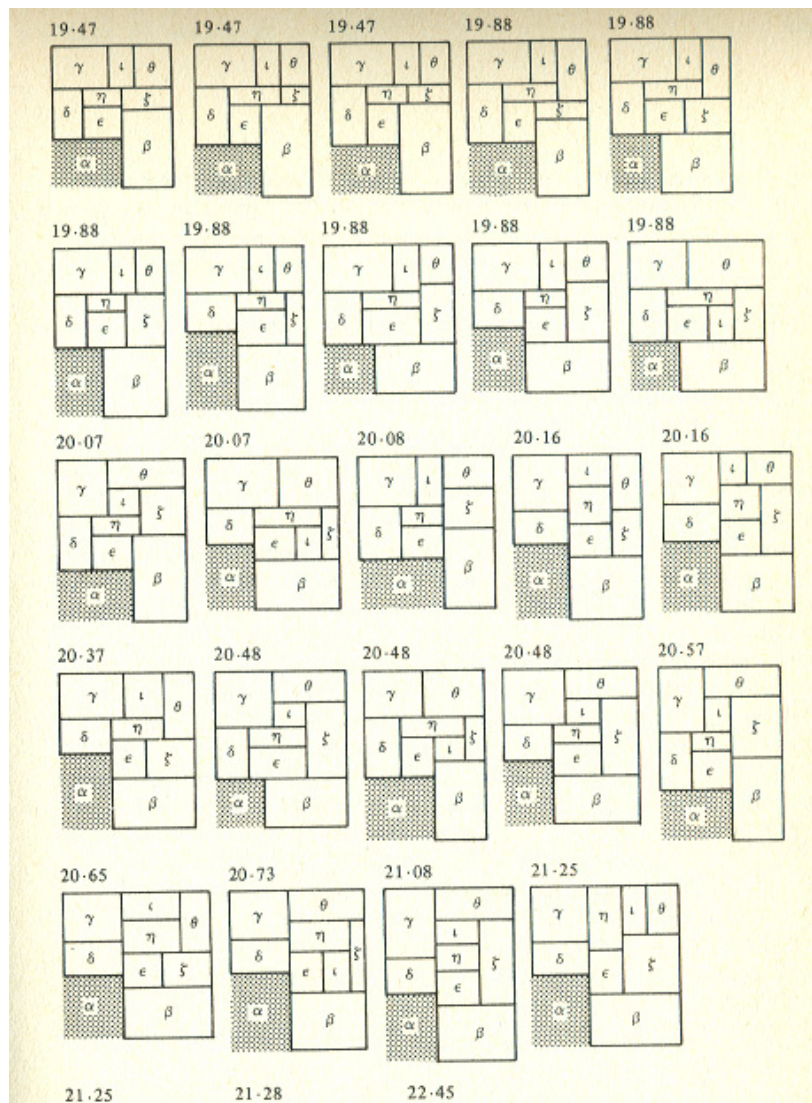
Familia de plantas generadas a partir de una única planta arquitectónica.
